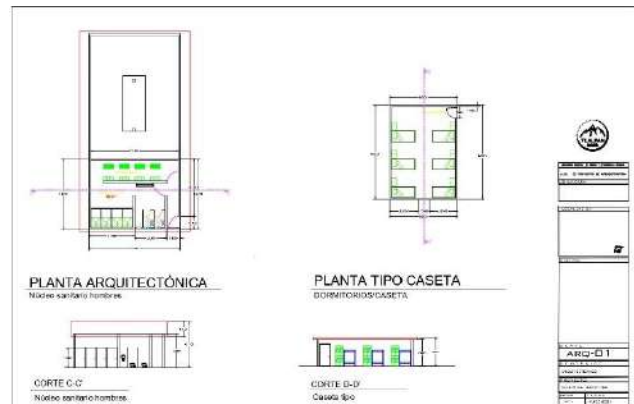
Propuesta base Guardia Nacional dormitorios. Foto LL
